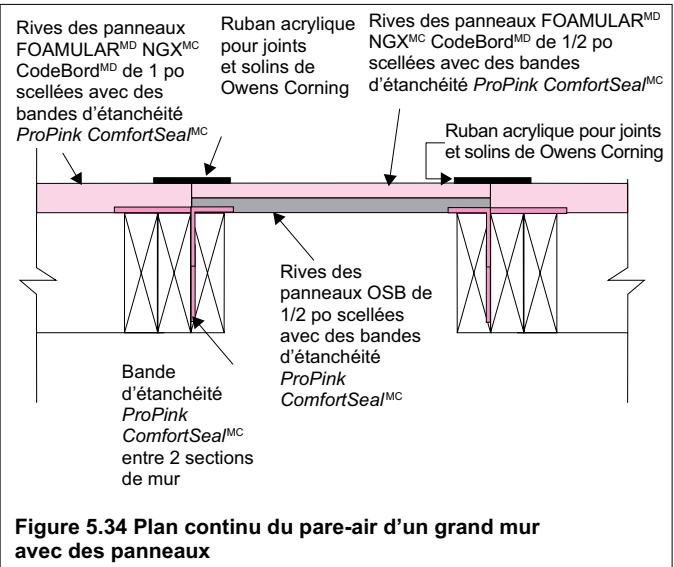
Plan continu du pare-air d'un grand mur avec des panneaux
